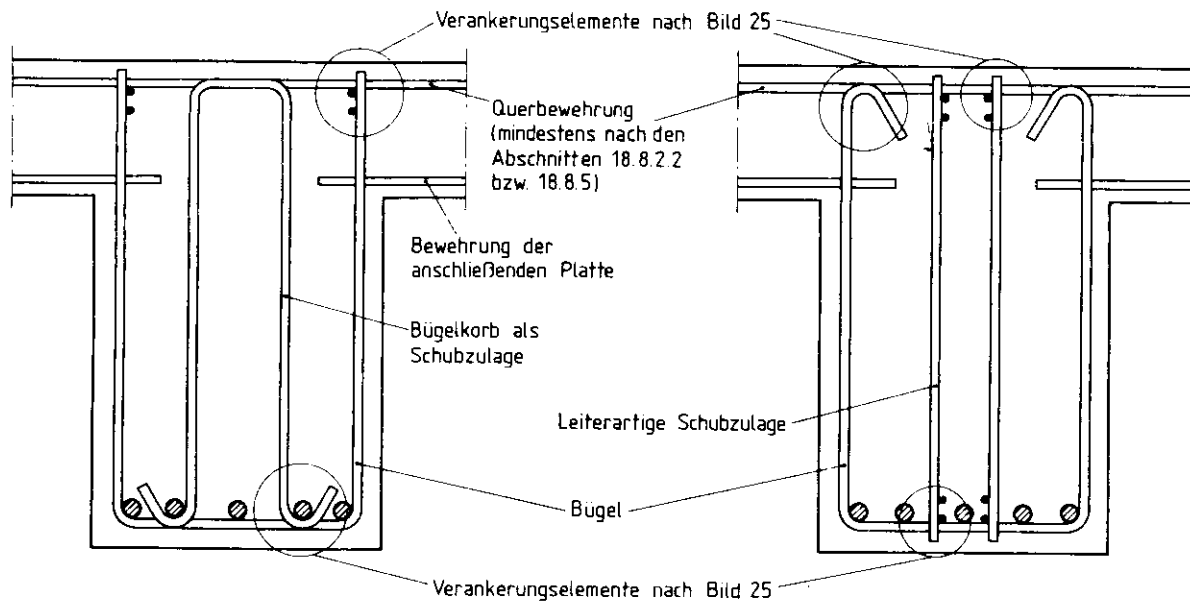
Beispiel für eine Schubbewehrung aus Bügeln und Schubzulagen in Plattenbalken
